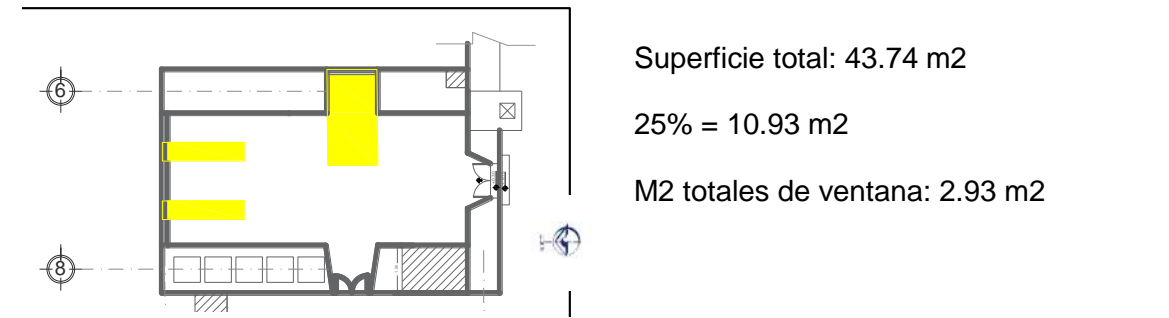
Plano de Iluminación natural en bautisterio. Autor GTN.
